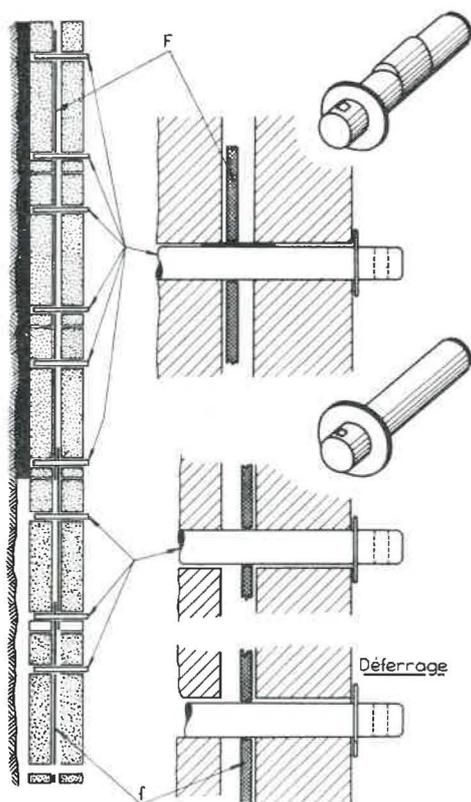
Broches à came, pour faciliter la reprise des plats de suspension après le bétonnage.
